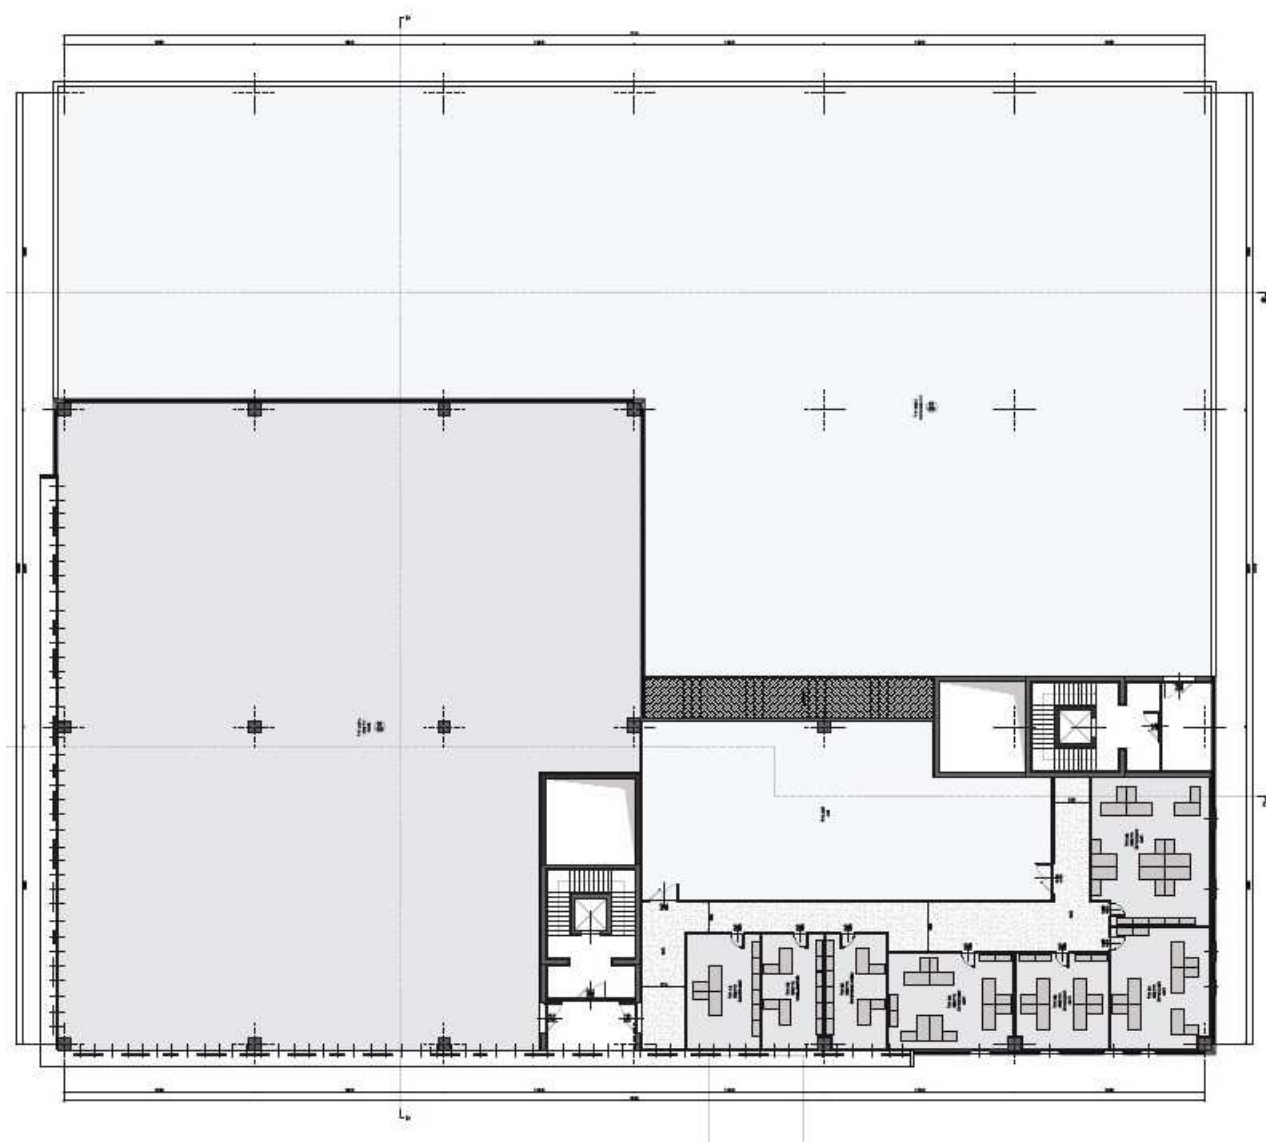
Edifici 2 e 3 Pianta piano secondo
